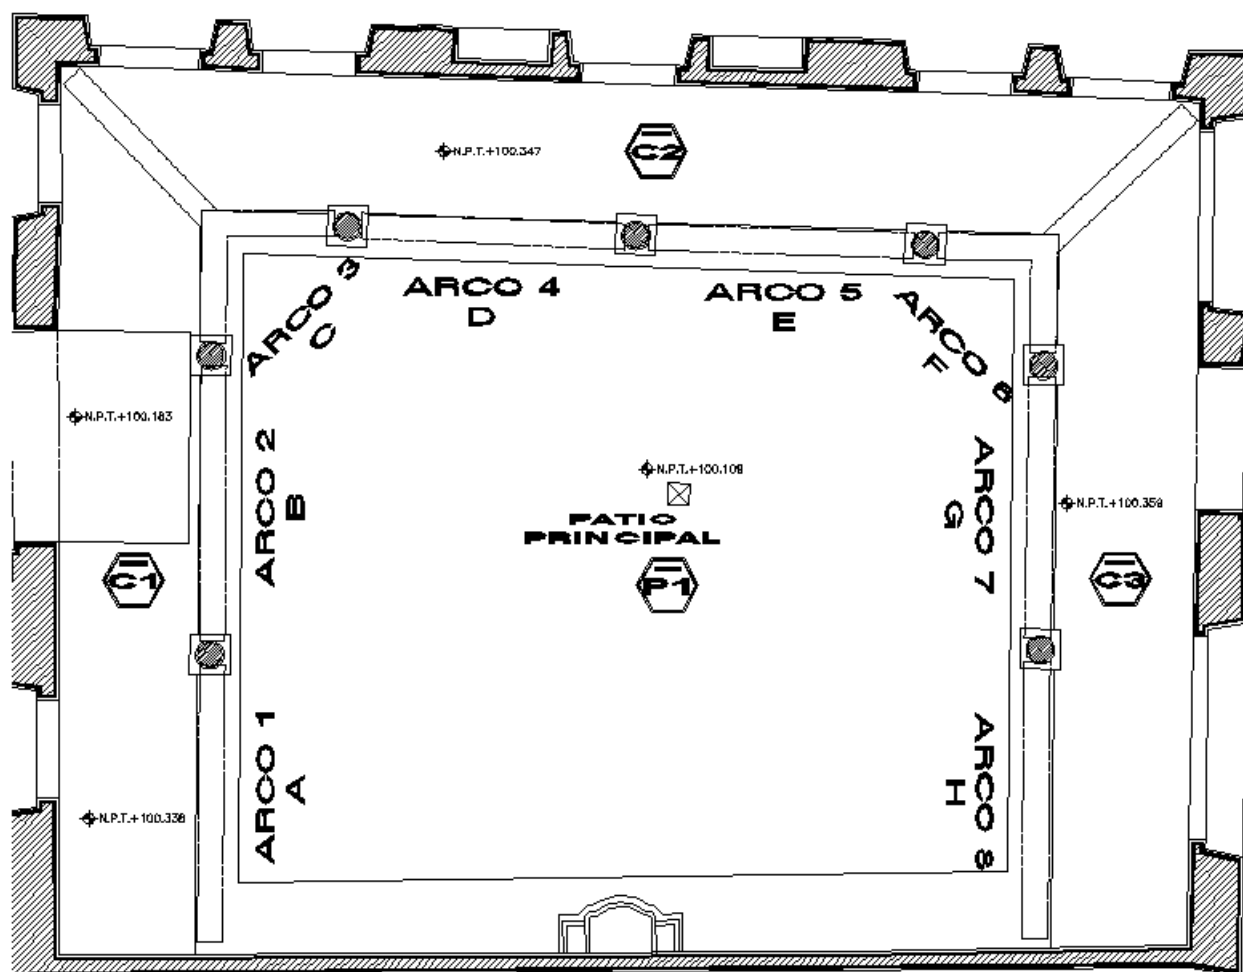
Se presenta la planta arquitectónica del patio principal, identificando su arquería.
